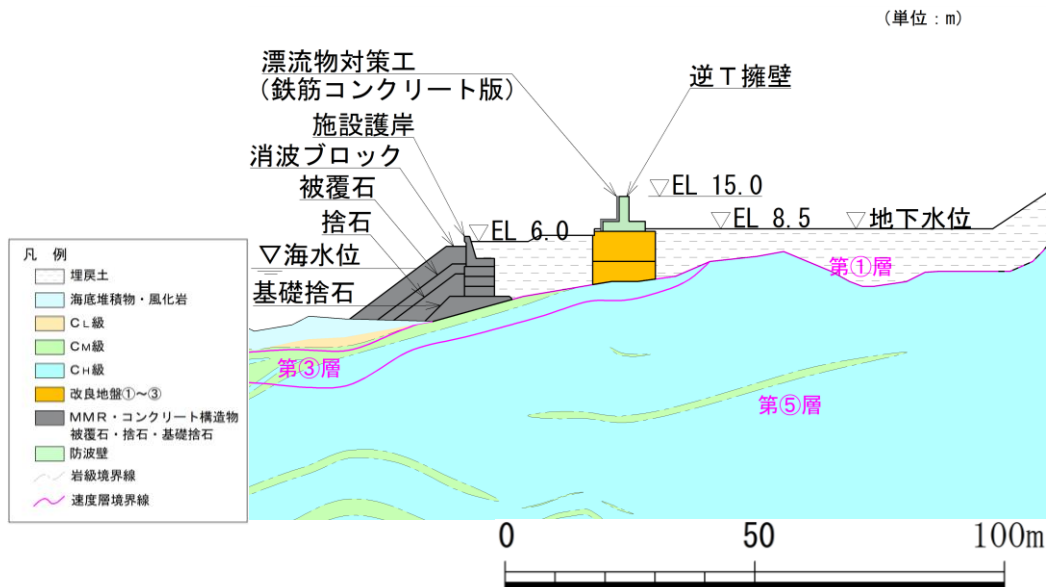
防波壁 (逆 T 擁壁) の横断面図 (②-②断面)
